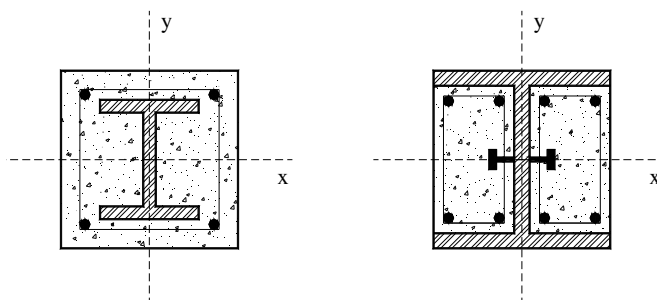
Pilares mistos de aço revestidos com concreto.
